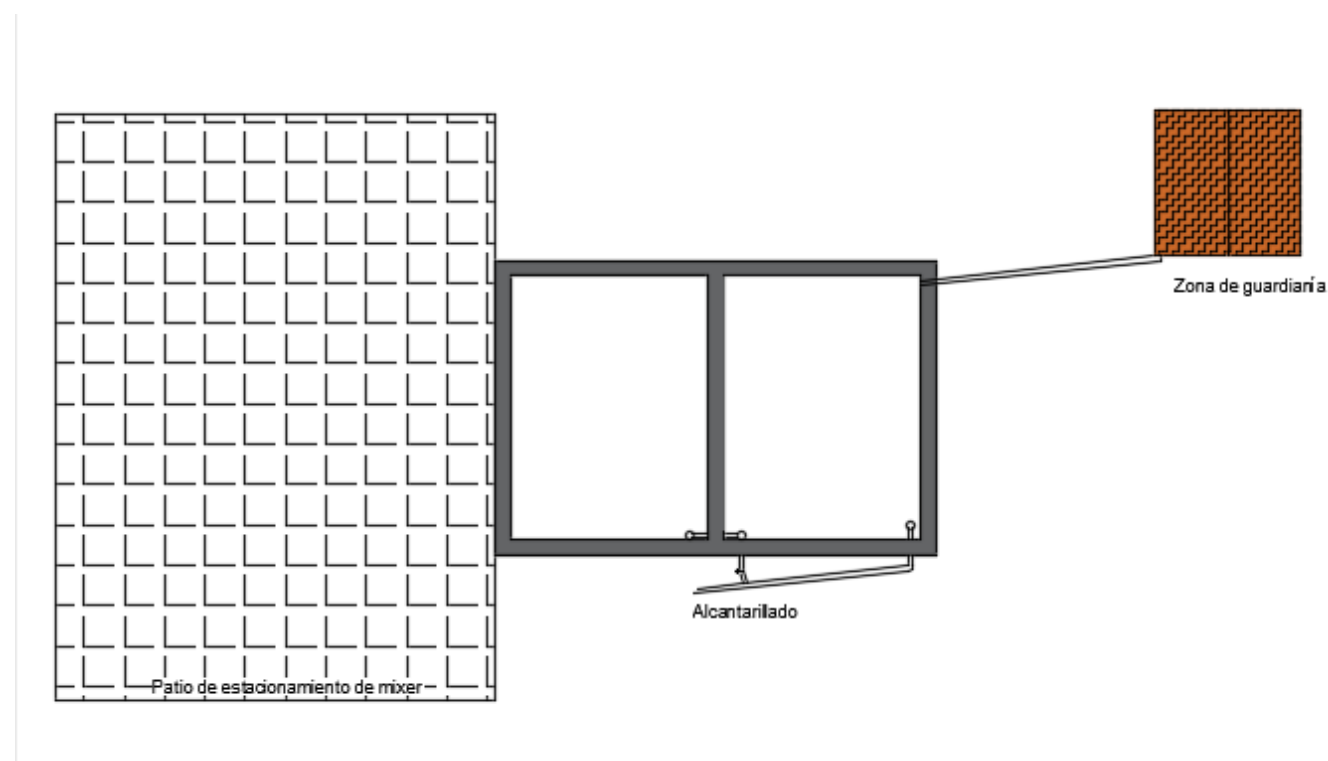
Esquema en planta de la zona de lavado de Mixers.
